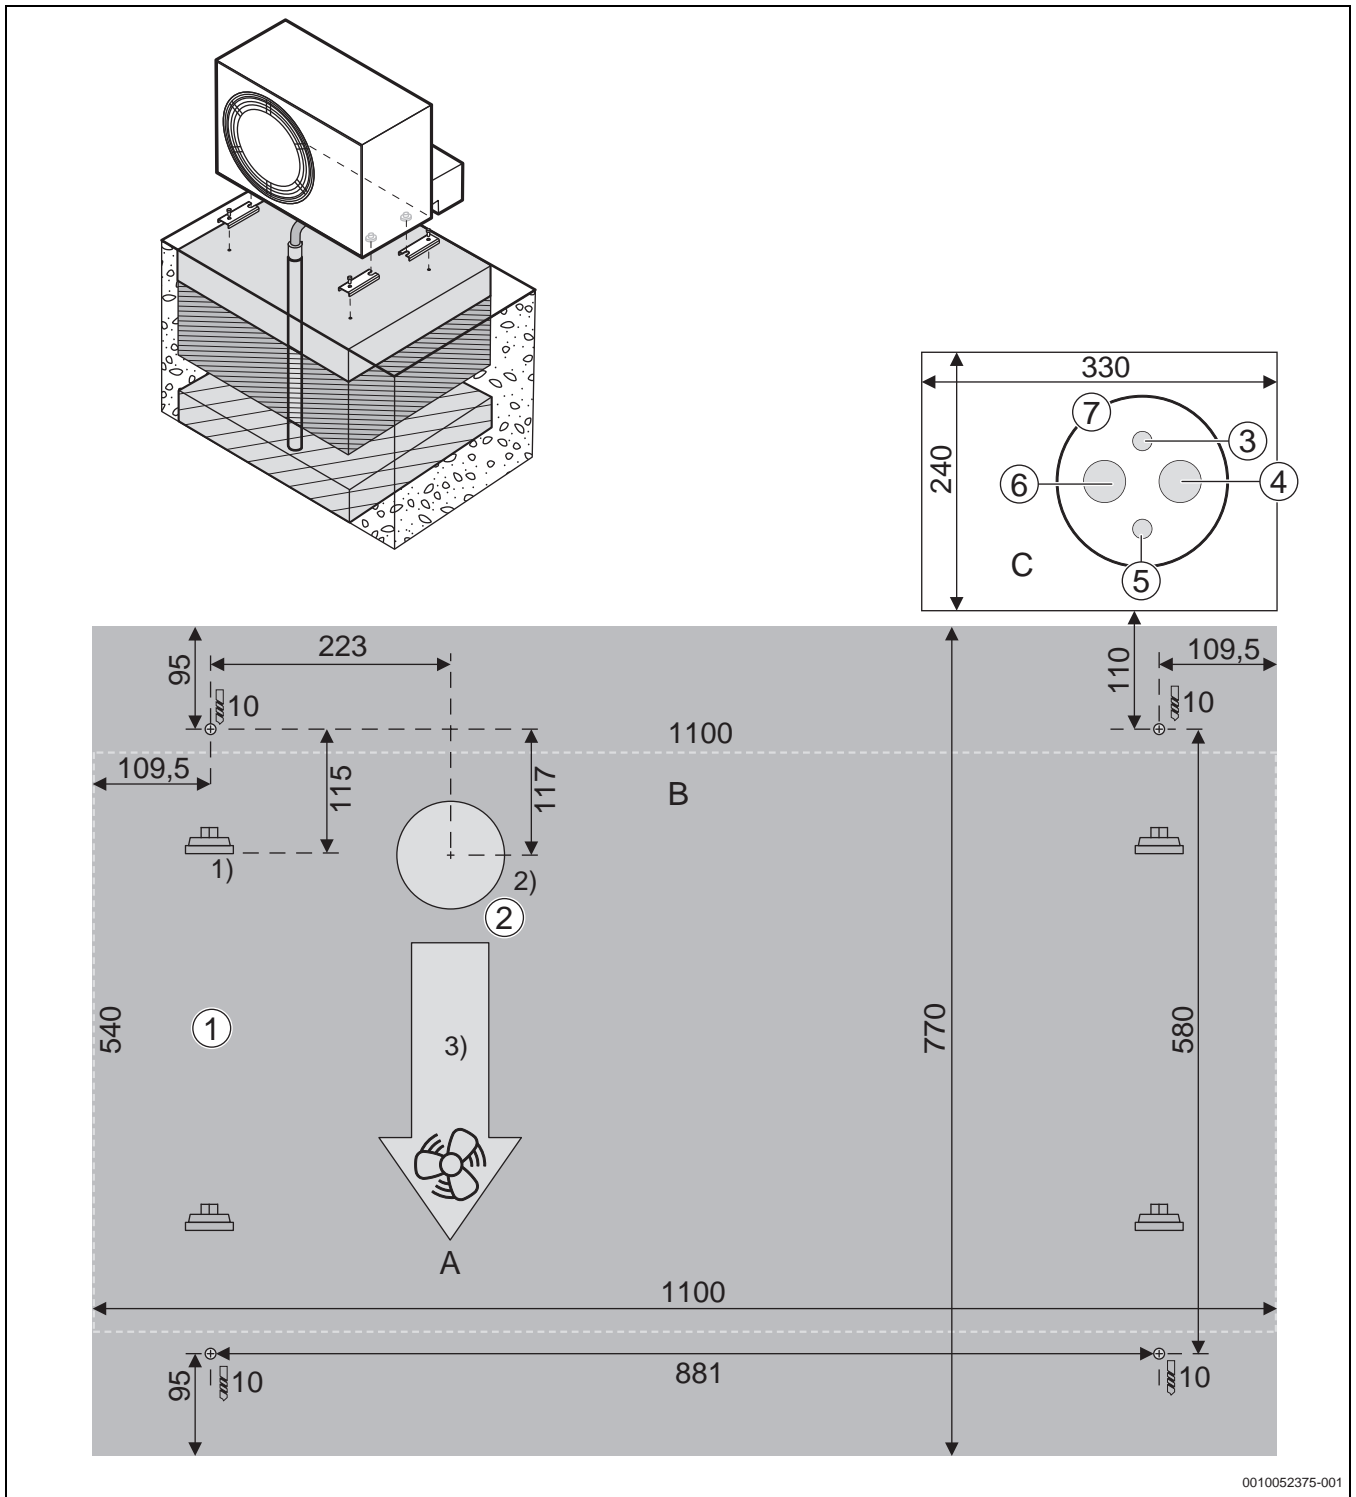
Befestigung der Wärmepumpe mit Montagesockel, Flächenfundament (Maße in mm)
